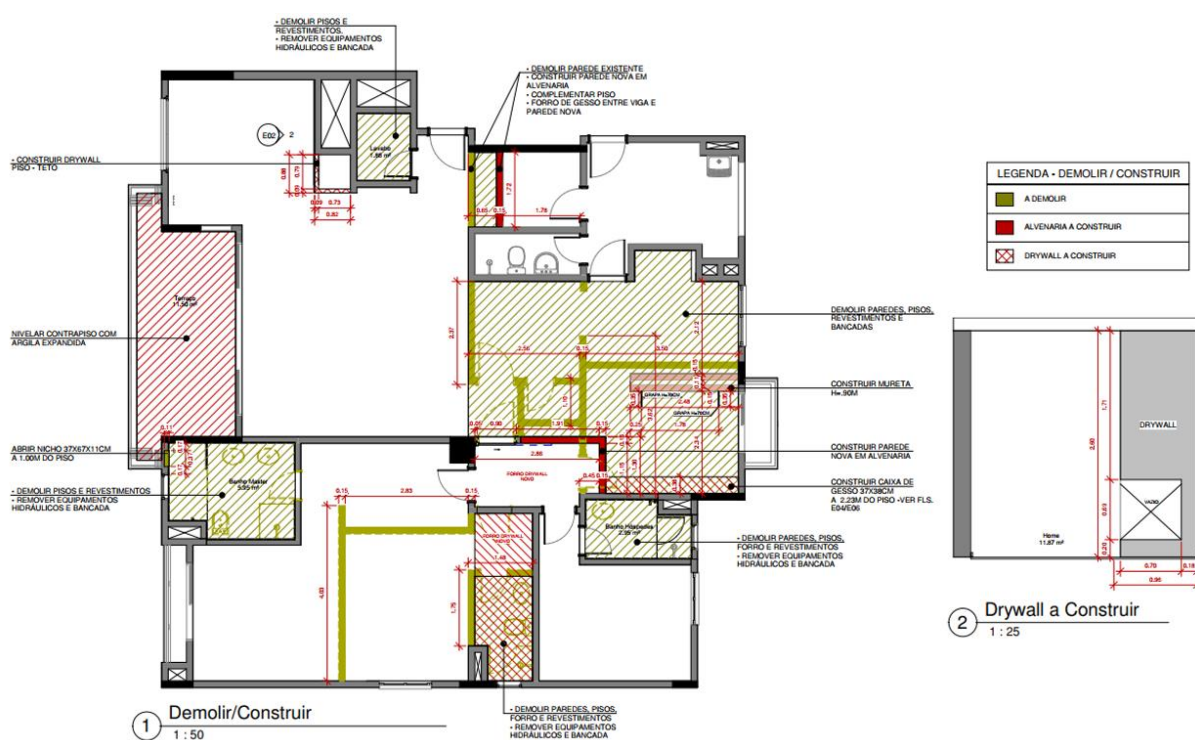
Estudo de Caso B – Planta de execução e demolição
